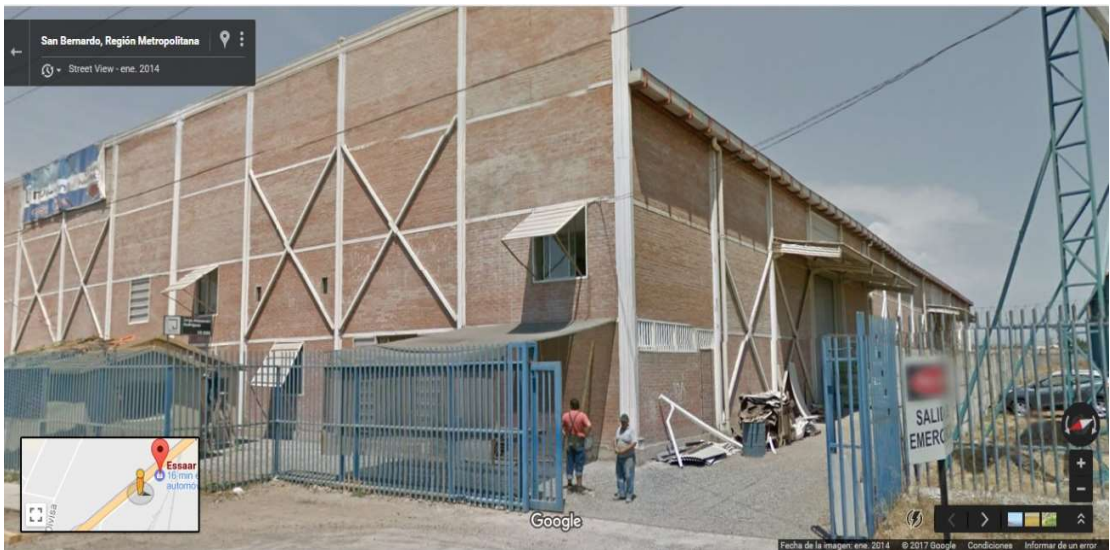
Edificio bodega de empresa ESSAR, vista entrada principal (Google Street view, 01/01/2014).
